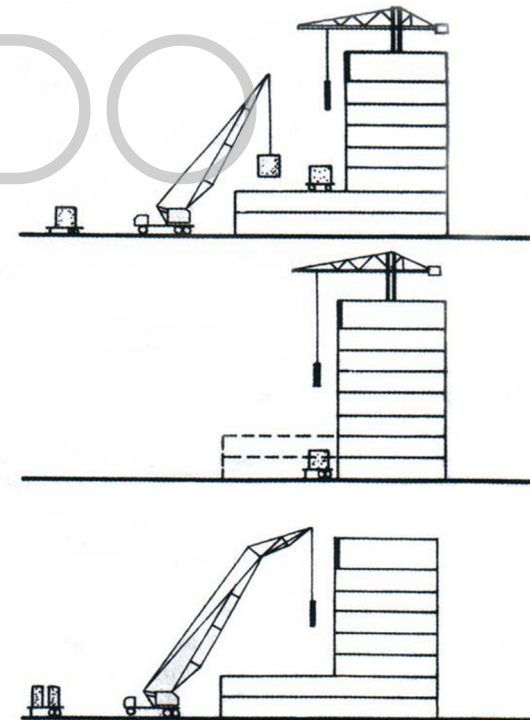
Montaje de panel prefabricado por medio de grúas
